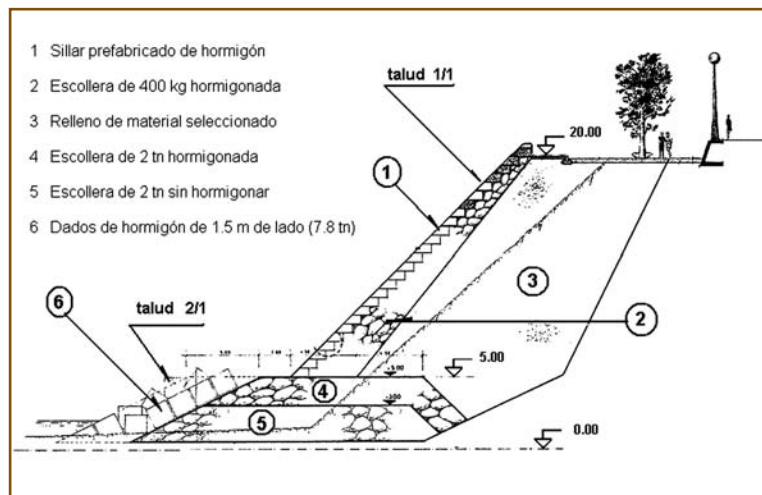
Sección transversal de la zapata tipo de hormigón que, con ligeras variantes, protege las murallas de la erosión en su pie y posterior socavación.
